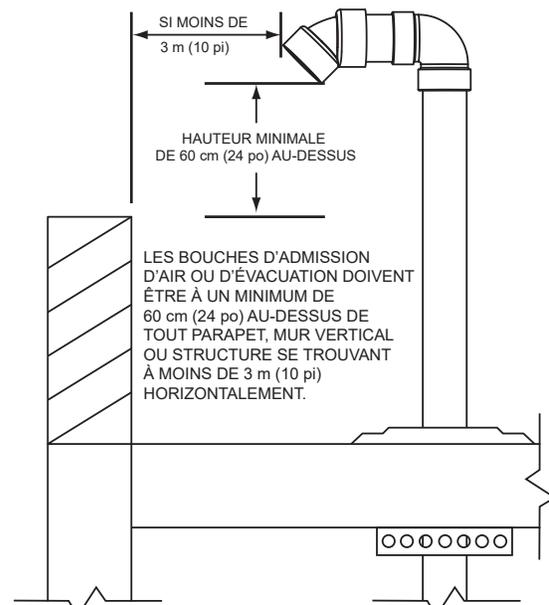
Extrémité(s) verticale(s) - Dégagement sur toit plat à parapet
